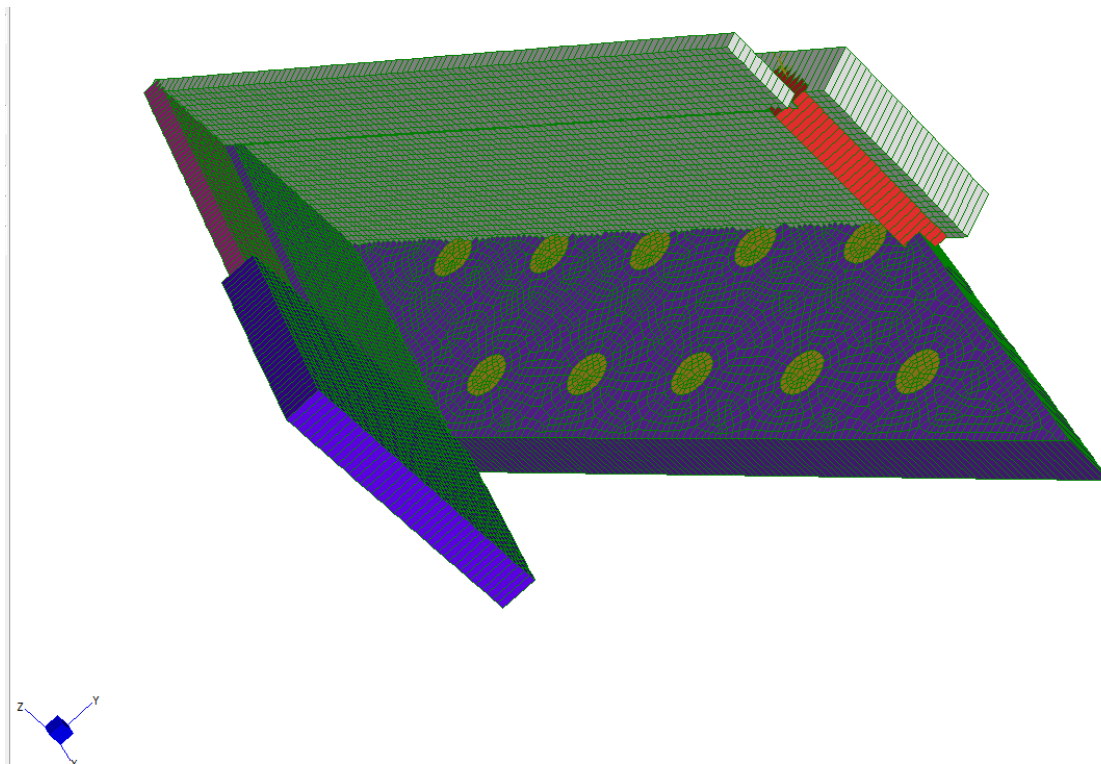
Modello con platea - Vista tridimensionale retro - Spalla 1
